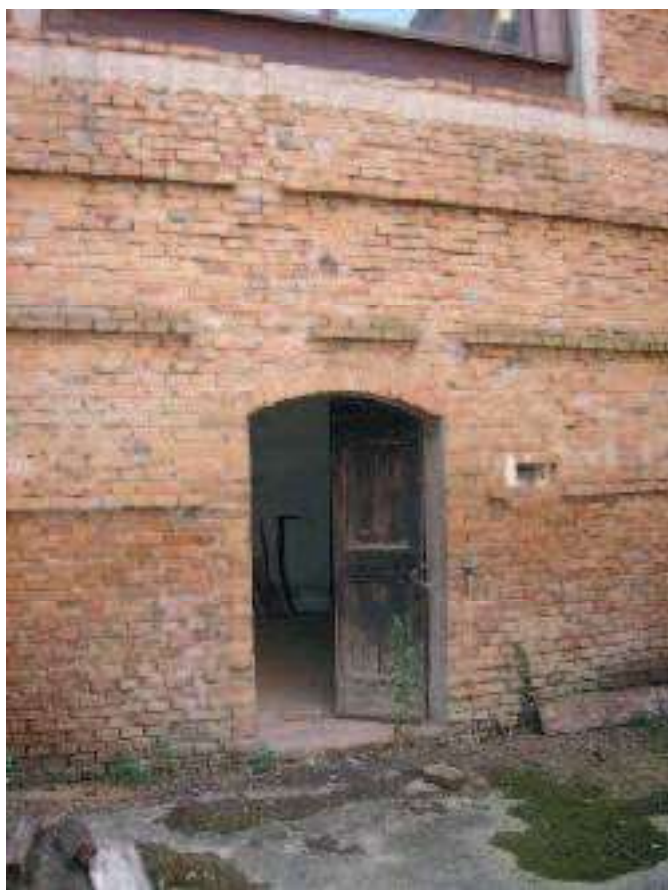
u.i. Sub.4 (corte) - lotto n.1 -
